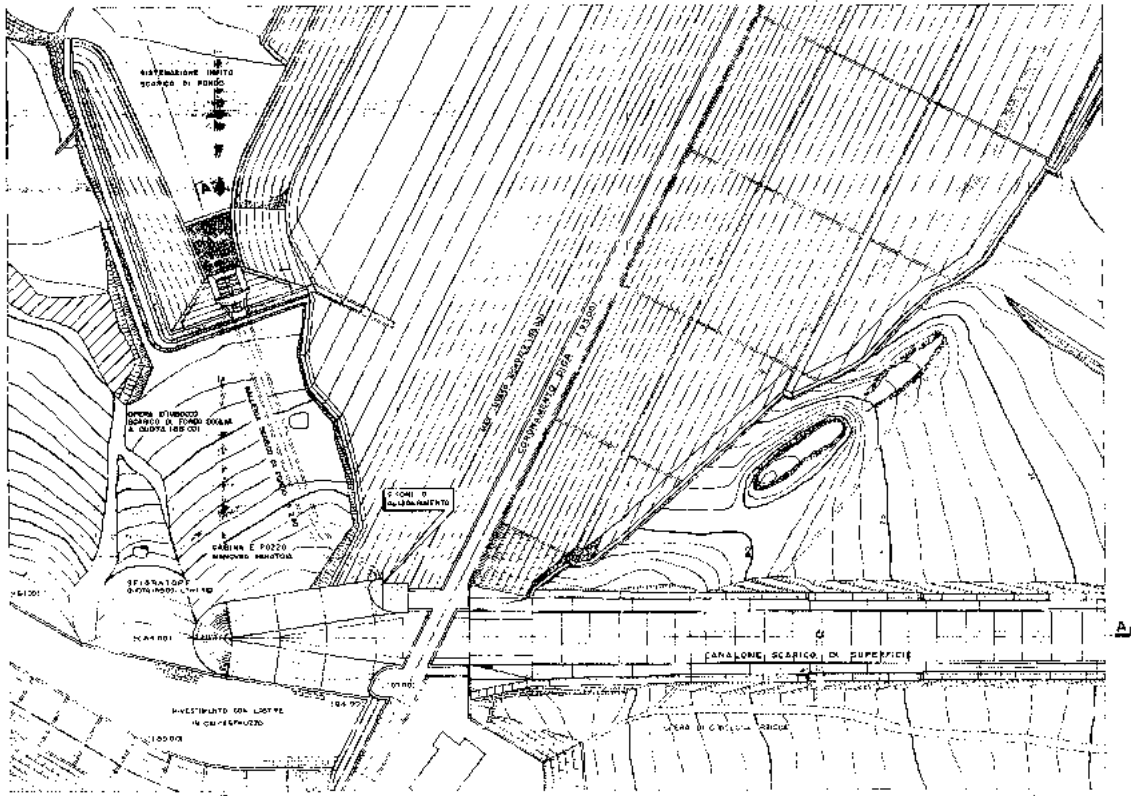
Planimetria delle opere di scarico della diga Comunelli
